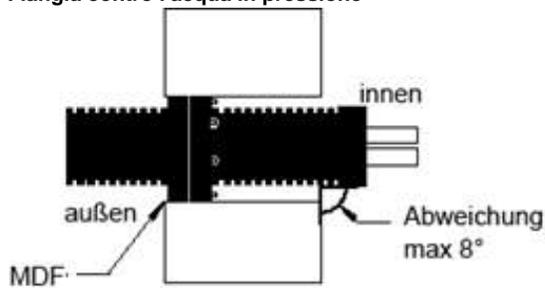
Schema di penetrazione nel muro con acqua in pressione
